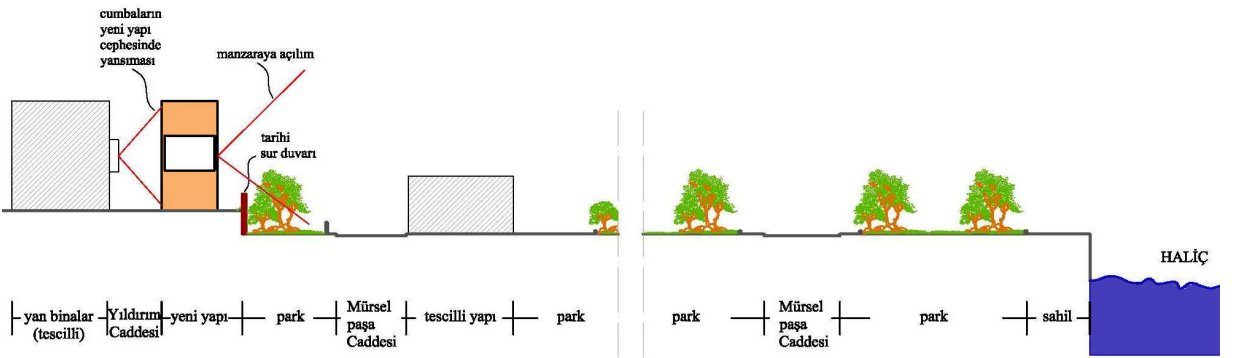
Yeni yapı önerisinin yer aldığı vaziyet planı
